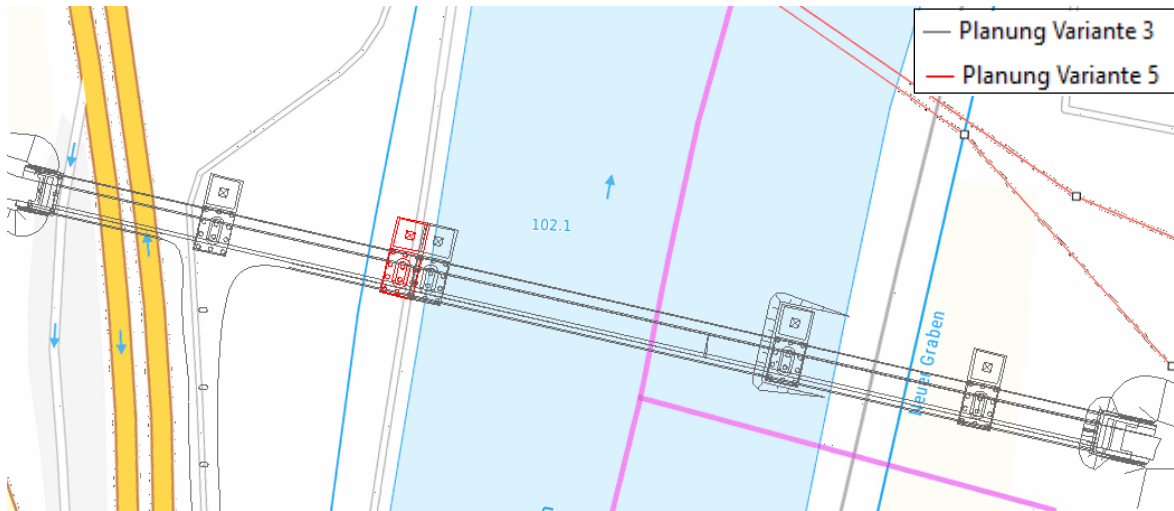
Lageplan: Planung Mainbrücke Variante 3 (SRP 2021; grau) und Planung Mainbrücke Variante 5 (SRP 2024, rot)
